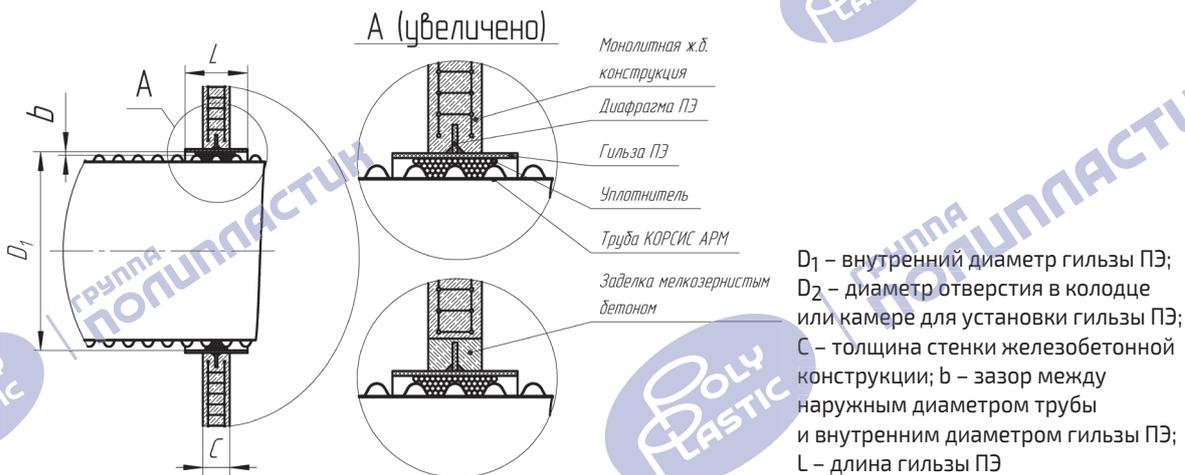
Ввод трубопровода «КОРСИС АРМ» в железобетонный колодец или камеру с различными вариантами заделки
